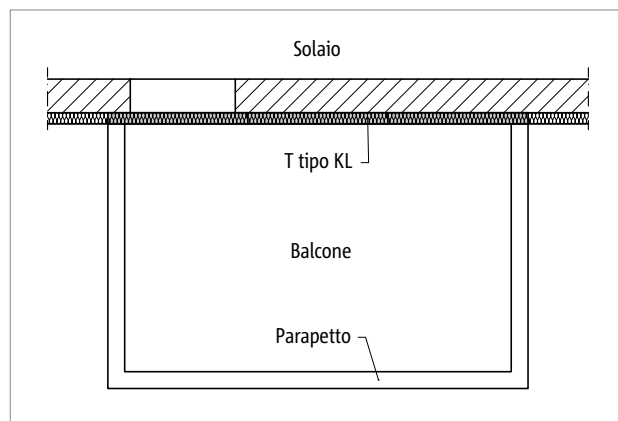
Disposizione di Schöck Isokorb® T tipo KL (variante 3)
